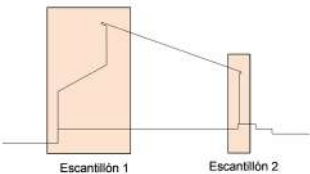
Escantillón muro de fachada sur en refugio para montañistas
